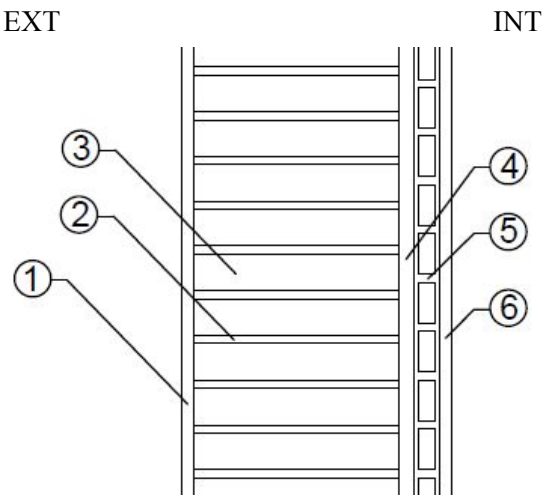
Sección muro tipo 1 (Fuente: Anejo A)
